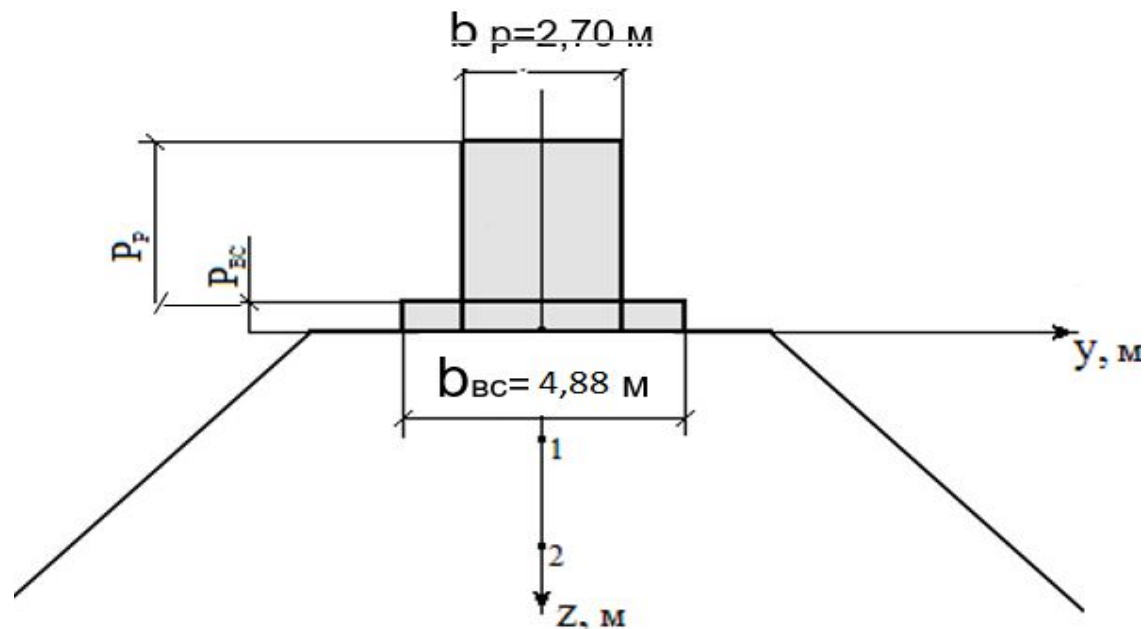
Расчетная схема для определения фиктивного столба грунта
